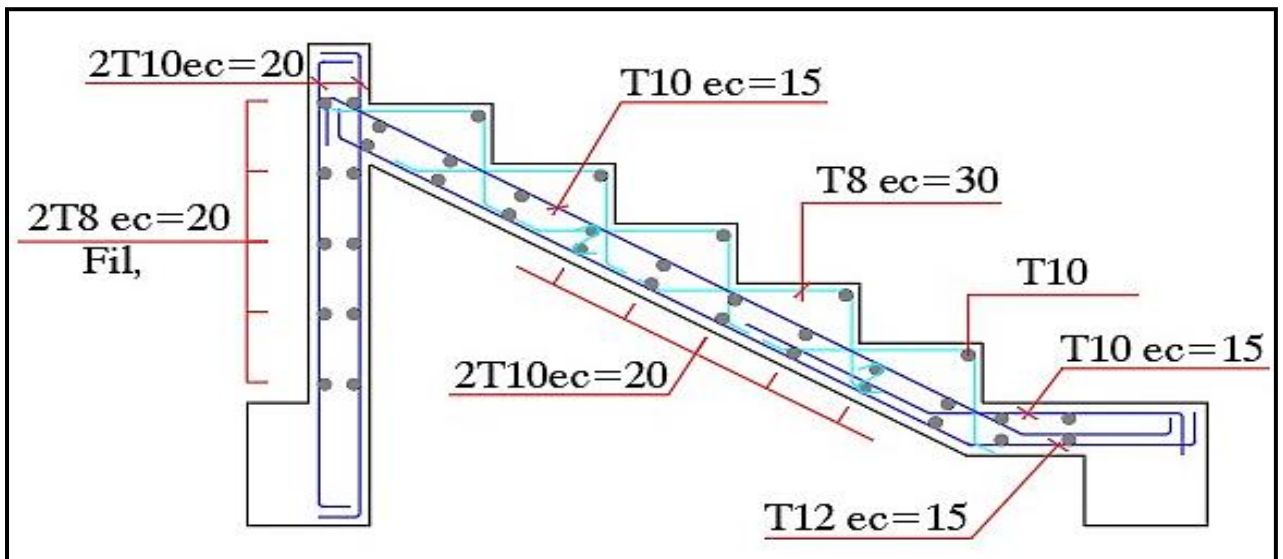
Schéma de ferraillage du 2^{ème}escalier.
